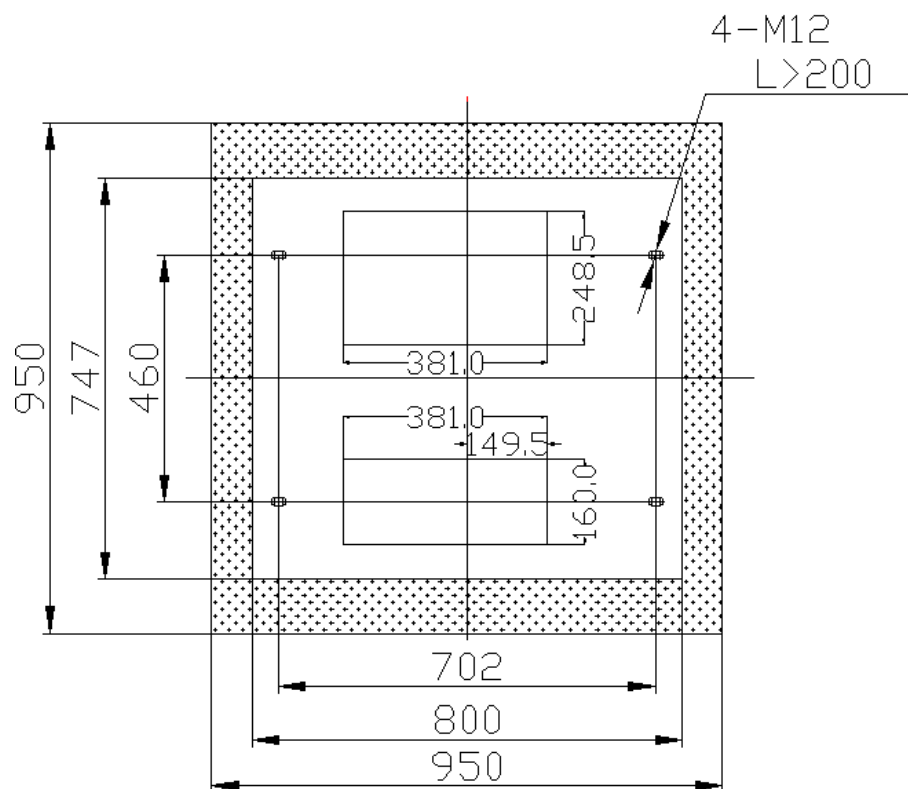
Schita de instalare a cabinetului de alimentare in beton
